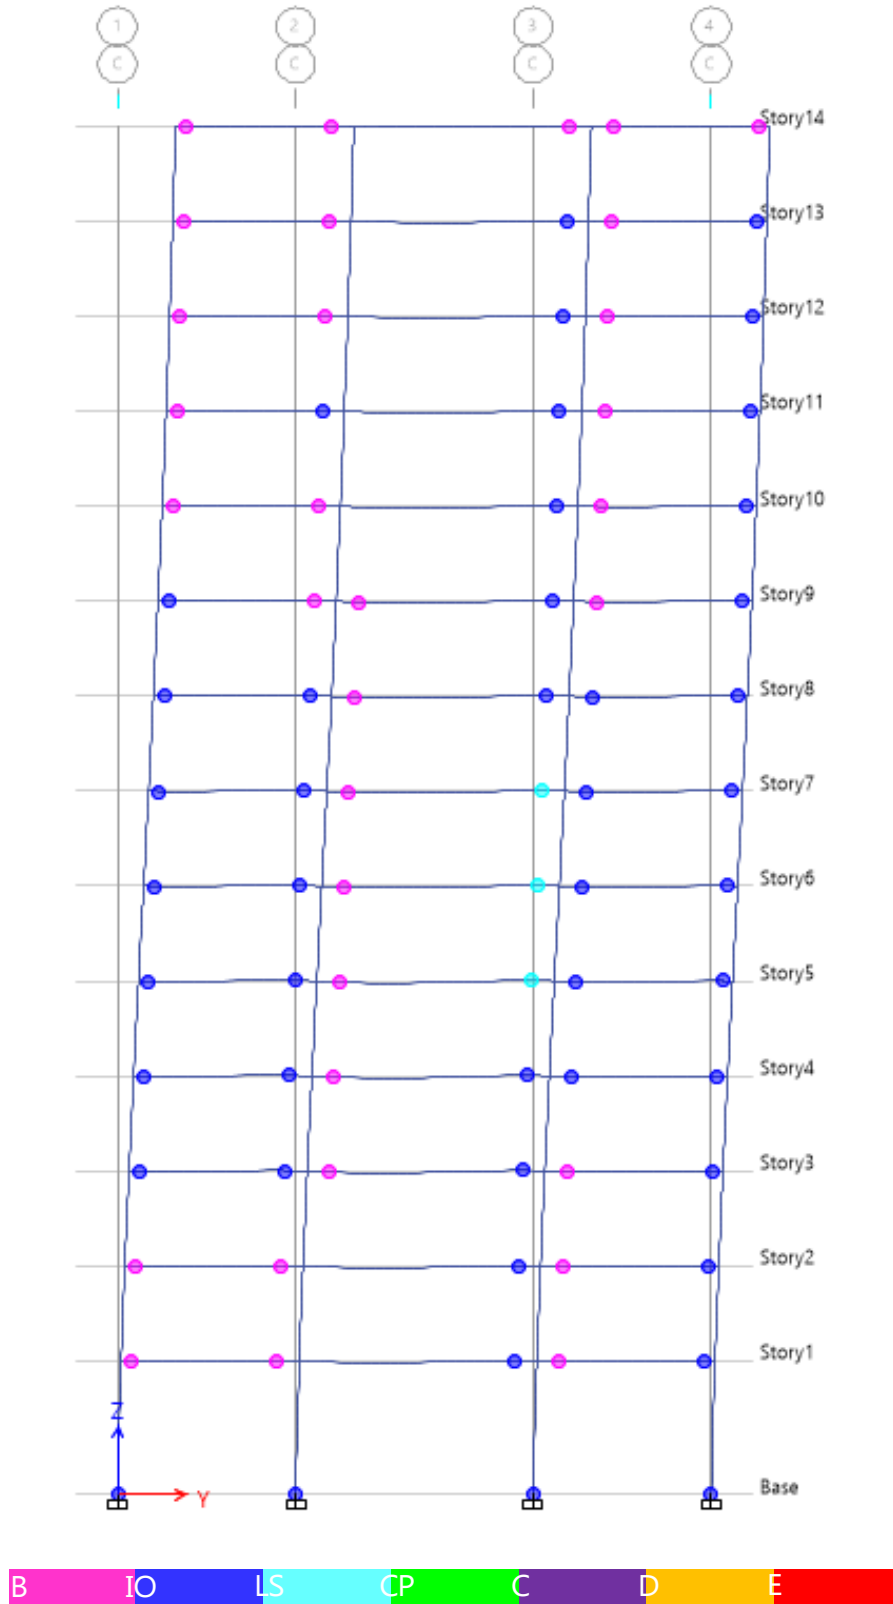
Formulación rótulas plásticas Eje D para BSE-2 en dirección y (Pórtico a momento hormigón armado ASCE 7-10).
